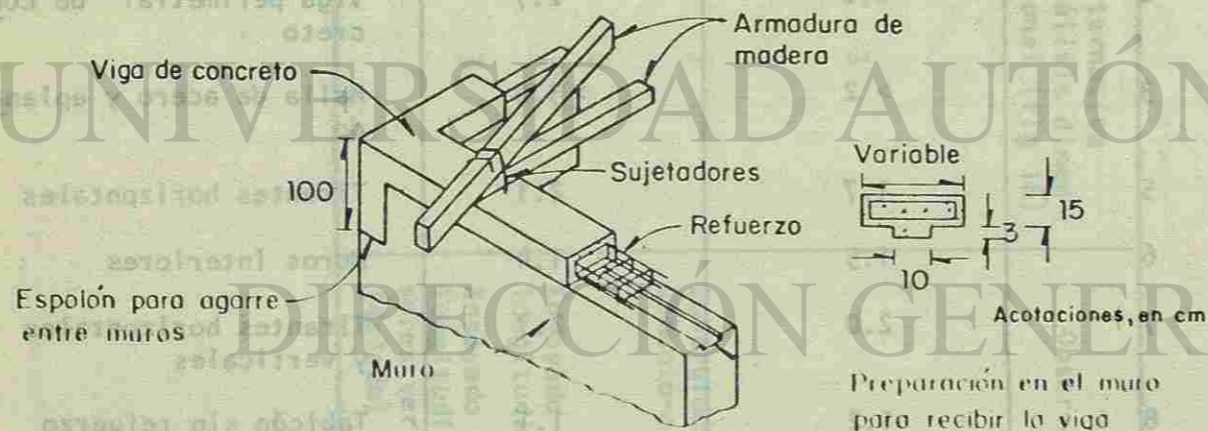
Refuerzo con viga cadena de concreto (ref 3)
